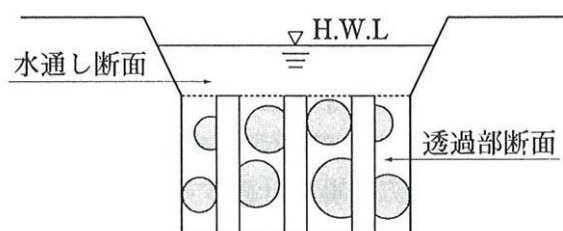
透過型砂防堰堤の水通し断面と透過部断面
